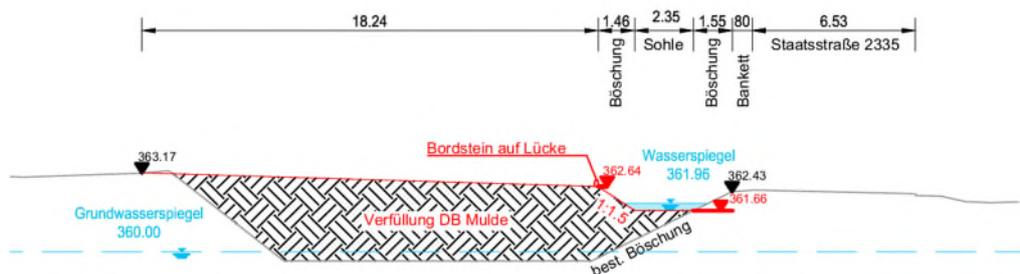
Lageplan und Schnitt der neuen Mulde entlang St 2335 gem. Wasserrechtsantrag vom 03.04.2023
